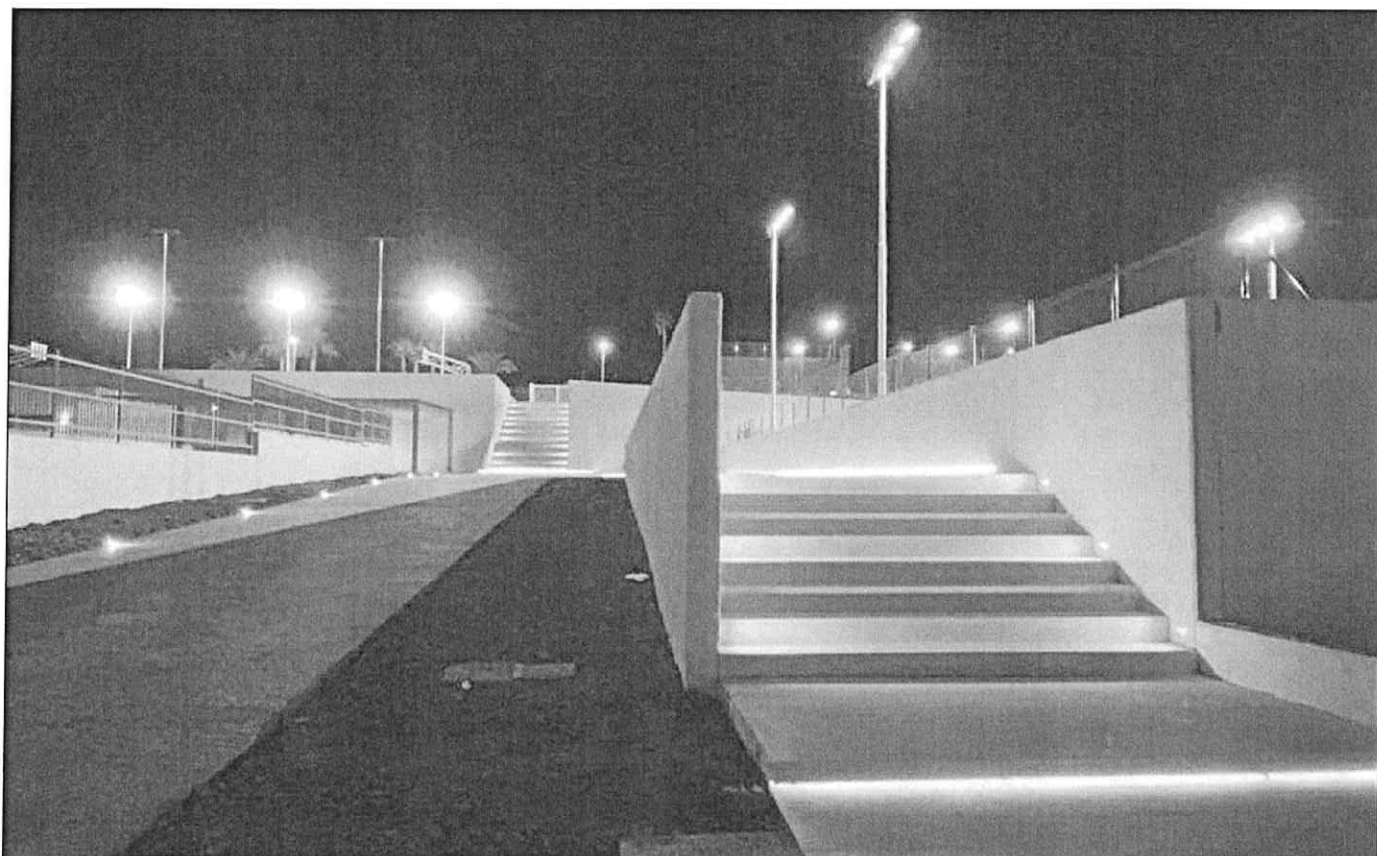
Ingresso e percorsi con illuminazione notturna
